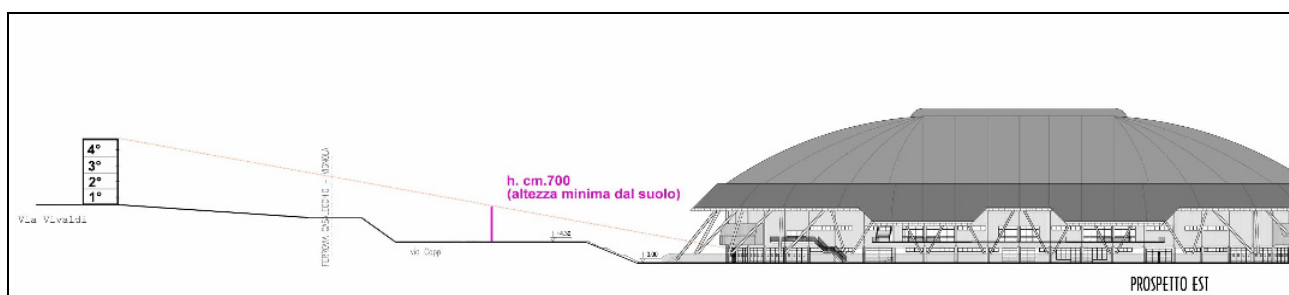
Stato di Progetto: dislocazione planimetrica elemento schermante (colore fucsia), di prevista installazione
